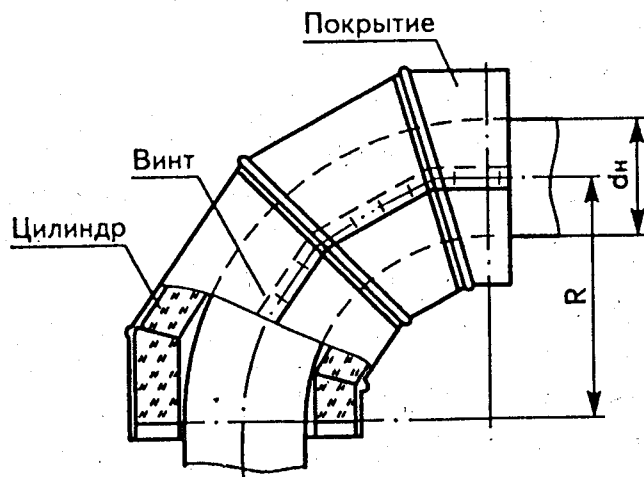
Изоляция отвода цилиндрами с металлическим секционным покрытием
